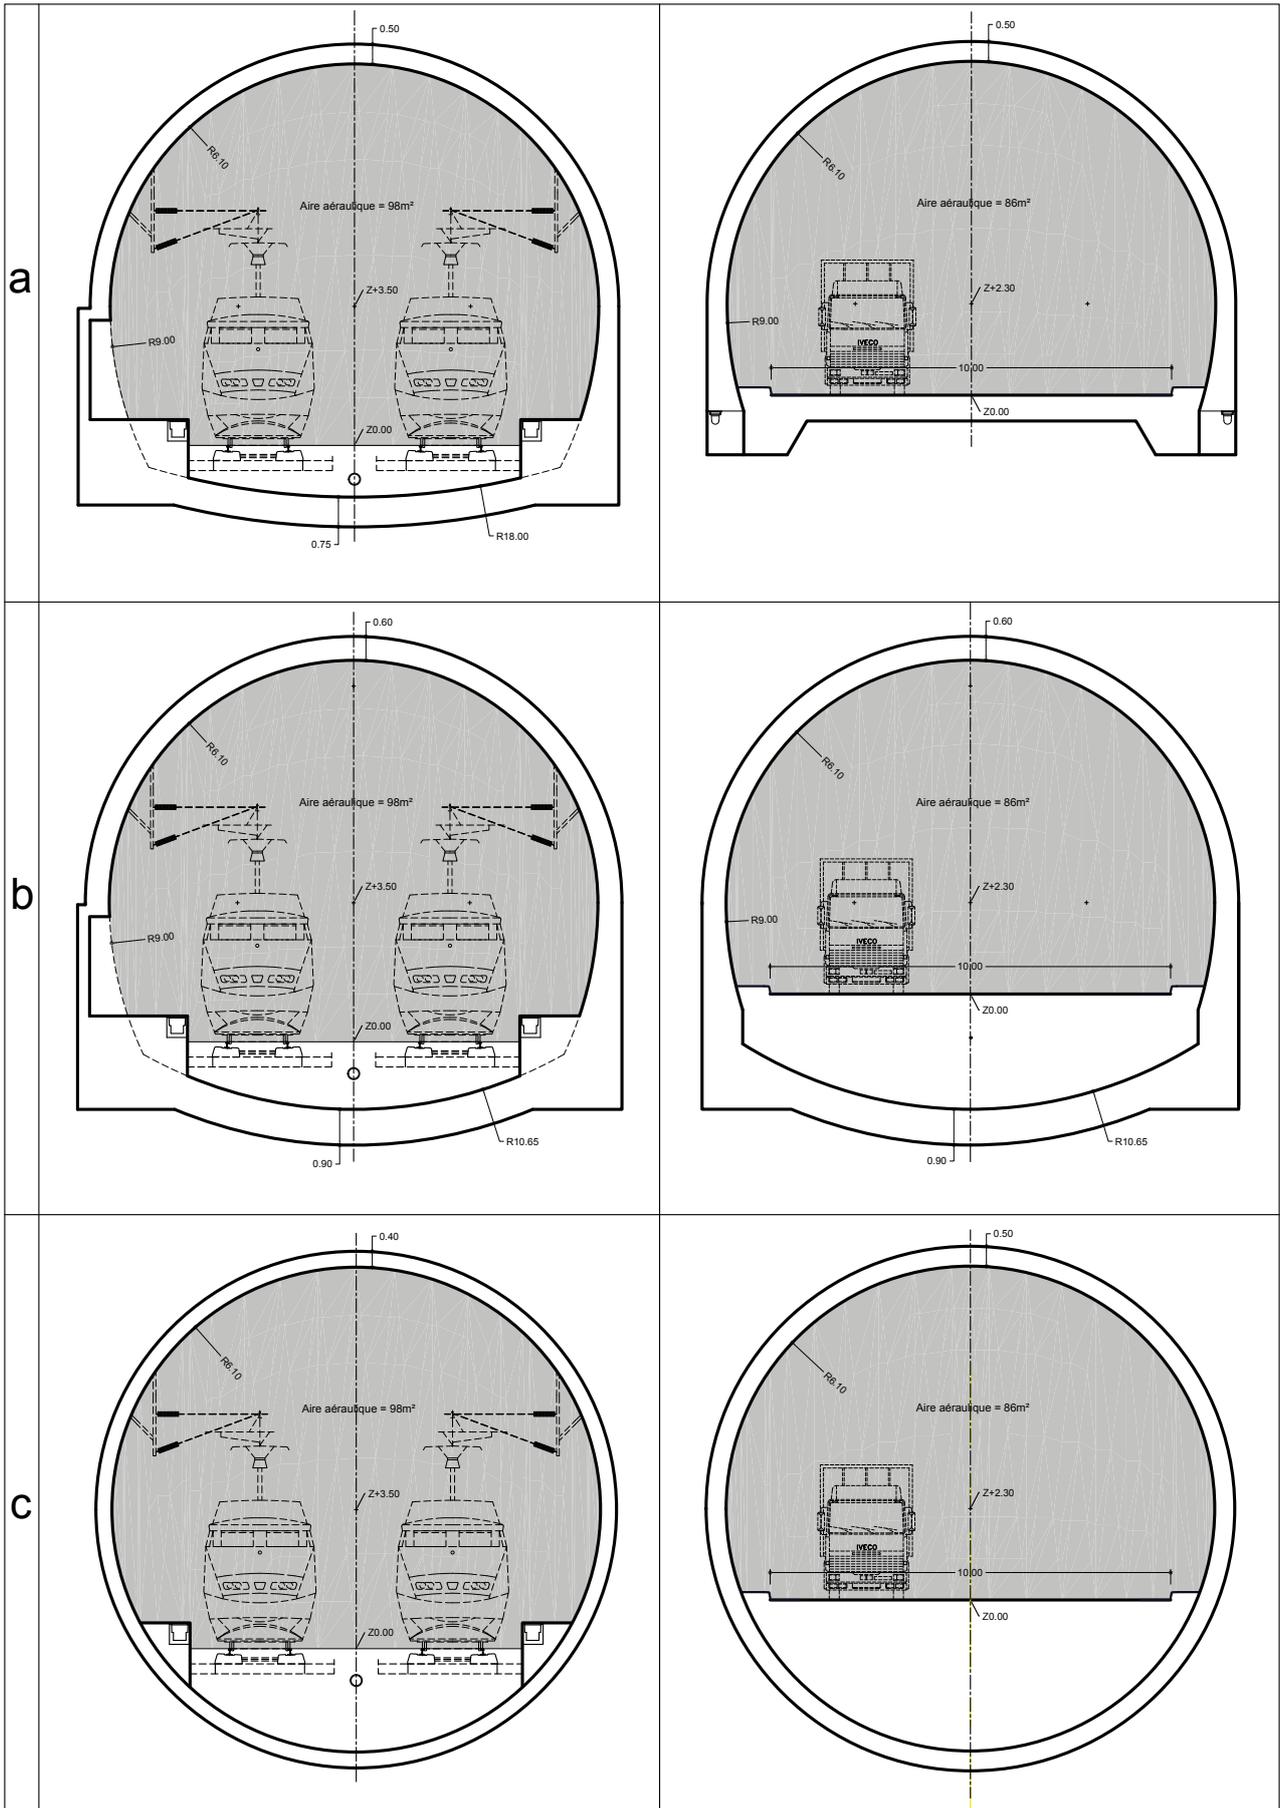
Sections transversales pour la géométrie D12 (à gauche : tunnels ferroviaires, à droite : tunnels routiers)
